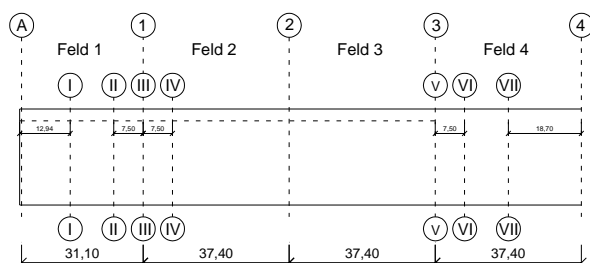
Ermüdungsrelevante Bereiche der Plattenbalkenbrücke
